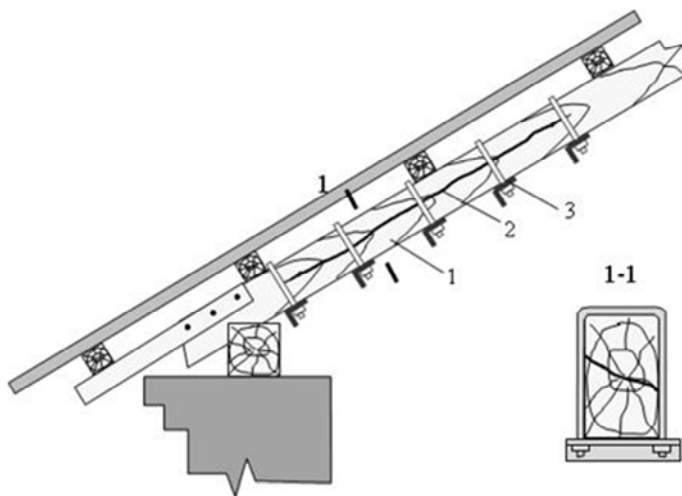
Усиление деревянных элементов стягиванием стальными хомутами на болтах:
